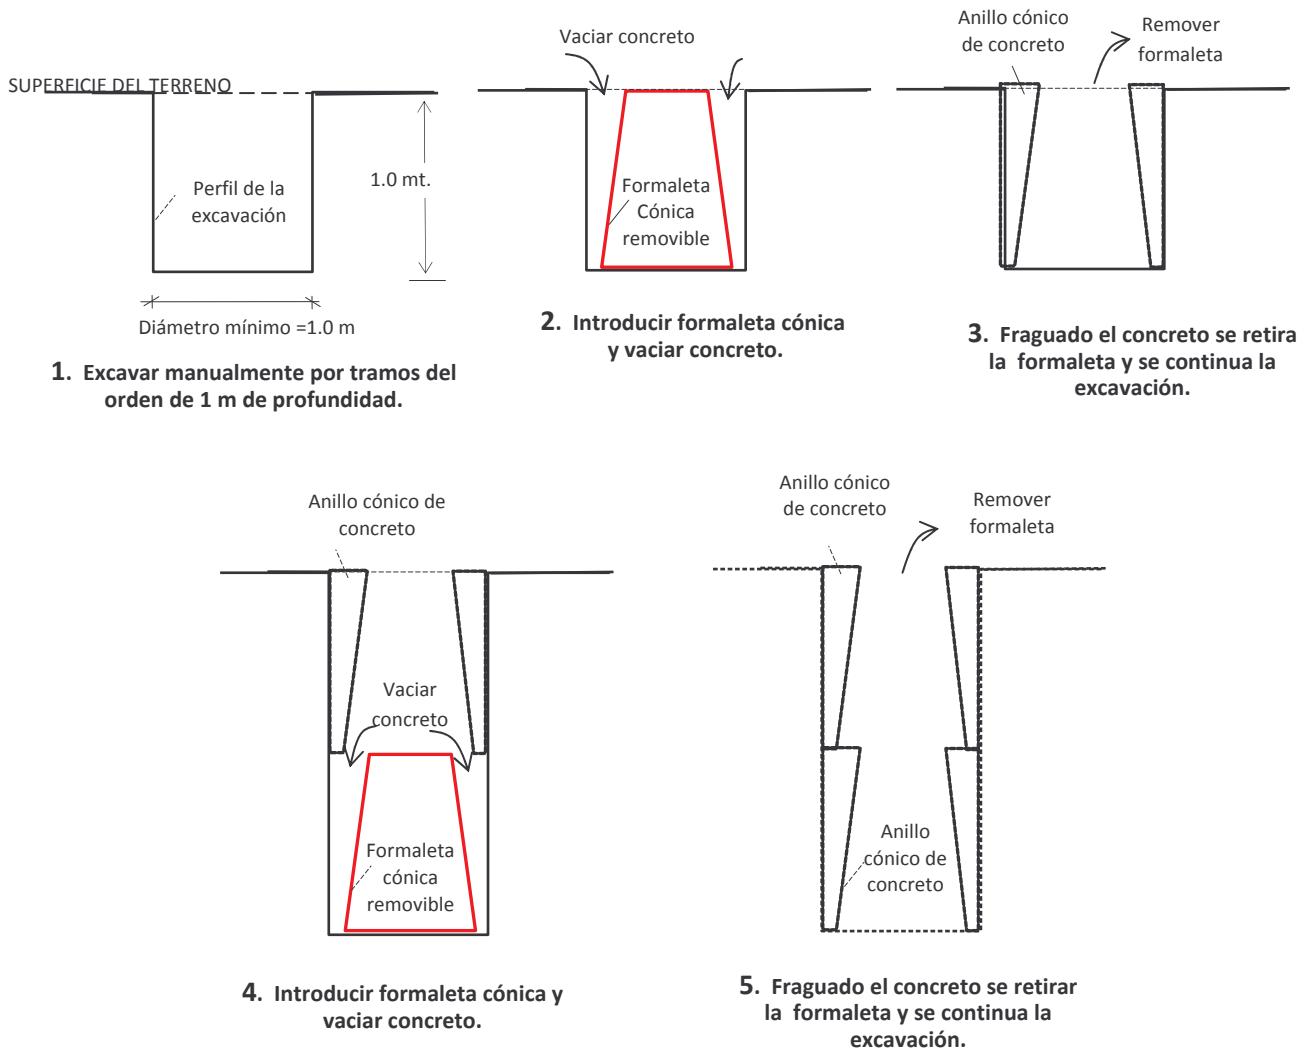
CONSTRUCCIÓN DE CAISONS
